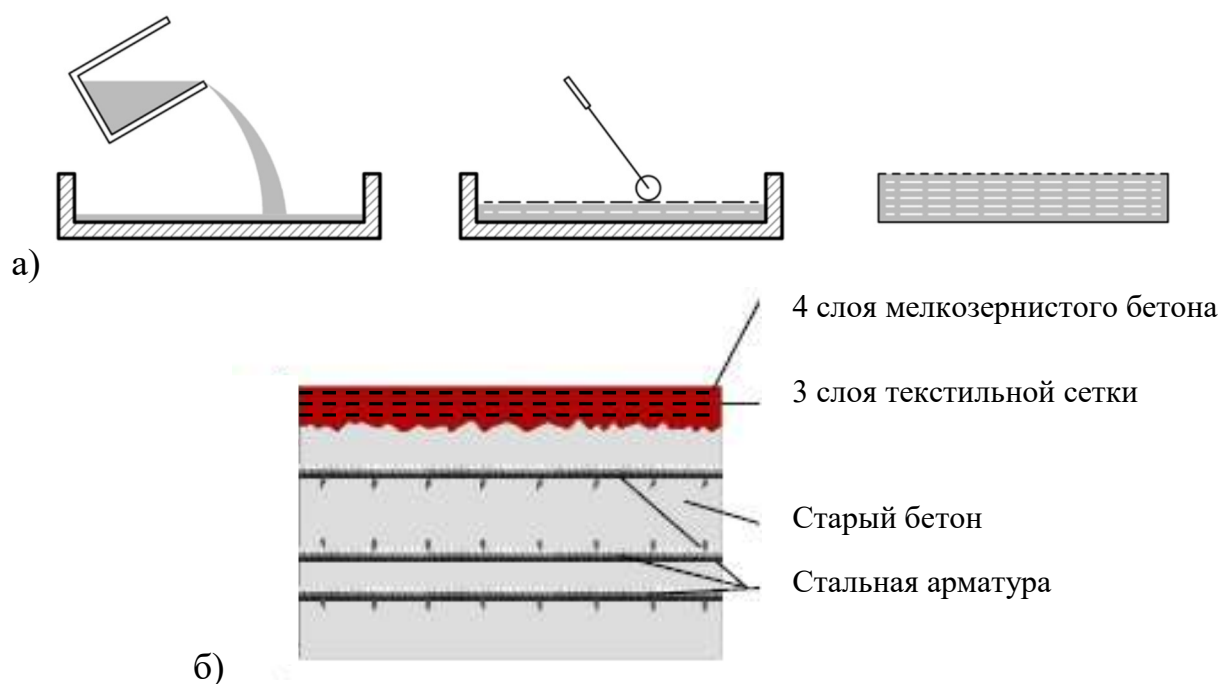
Схема приготовления текстиль-бетона послойной укладкой в опалубке (а) и при усилении железобетонных конструкций (б)
